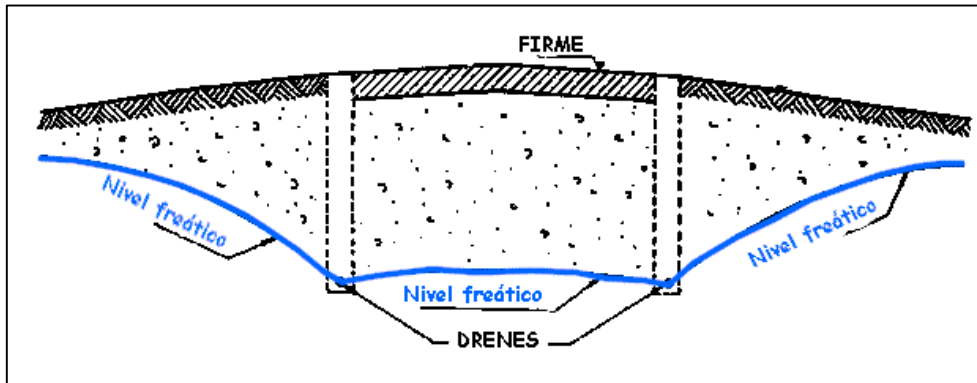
Croquis de pantallas drenantes actuando para rebajar el nivel freático
